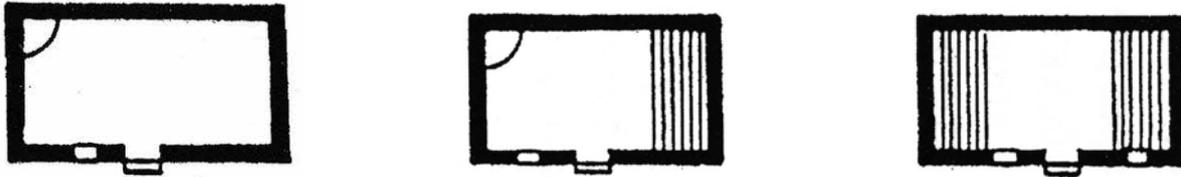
Varianten des einstöckigen breitfrontigen Hauses: Grundriss-Schemata
